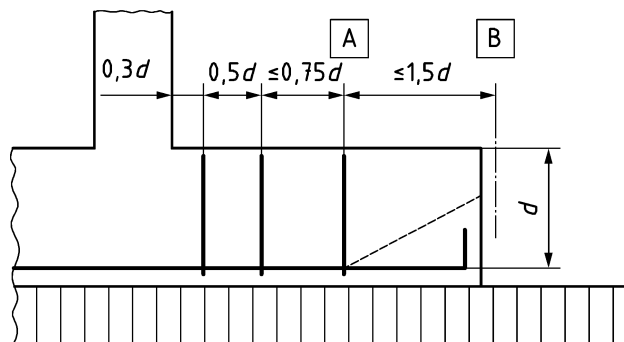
wird durch Bild 9.10DE ersetzt.
